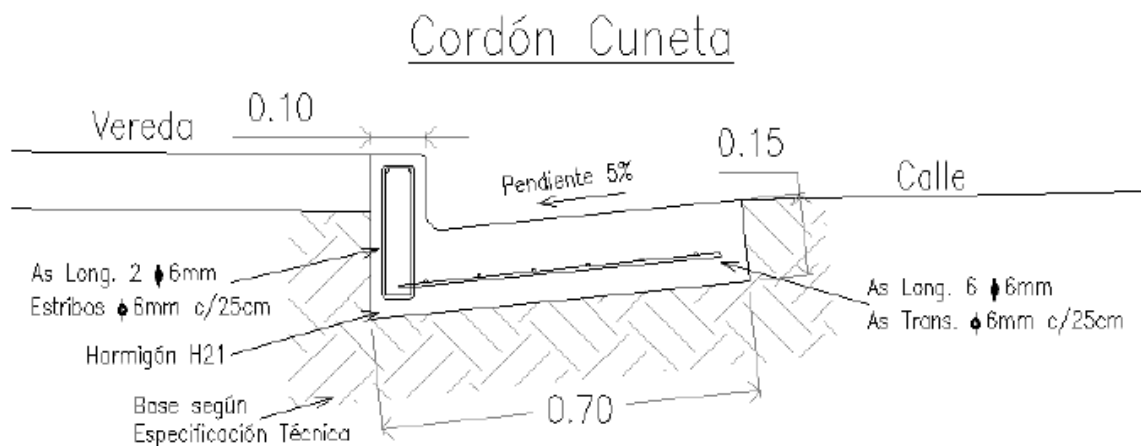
| Perfil transversal utilizado de cordón cuneta
